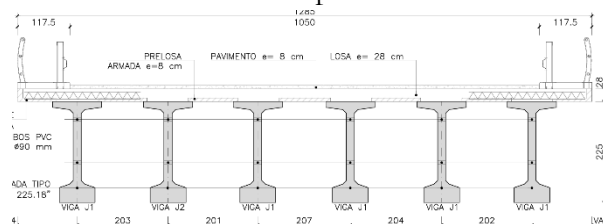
Sección transversal del nuevo tablero (PACADAR)
